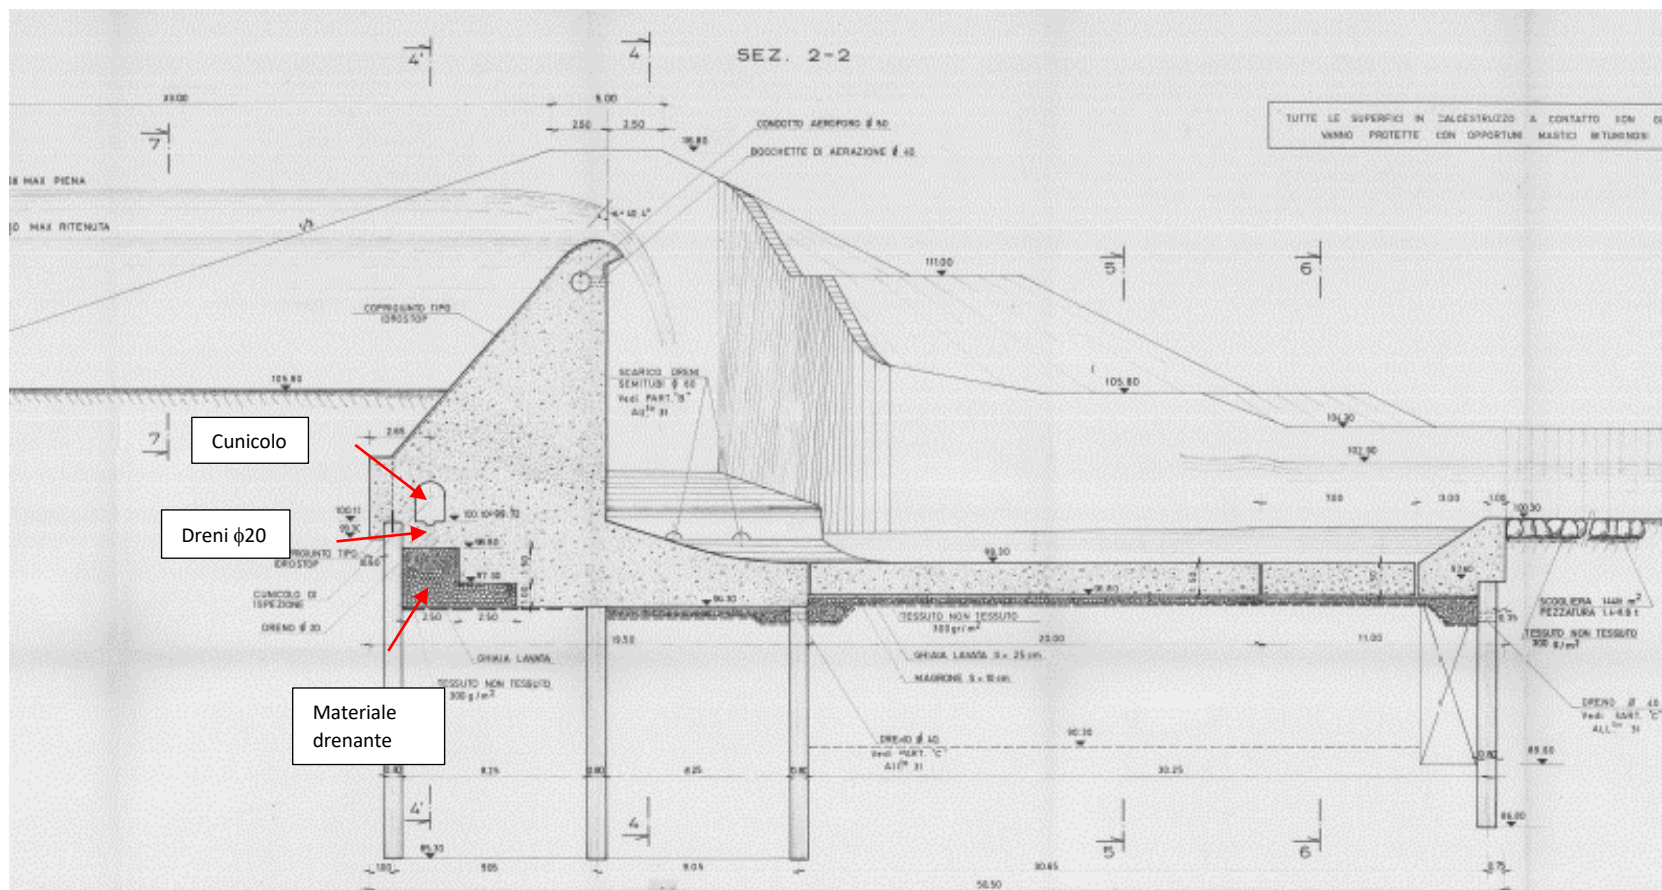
sezione longitudinale diga. Sistema di drenaggio
